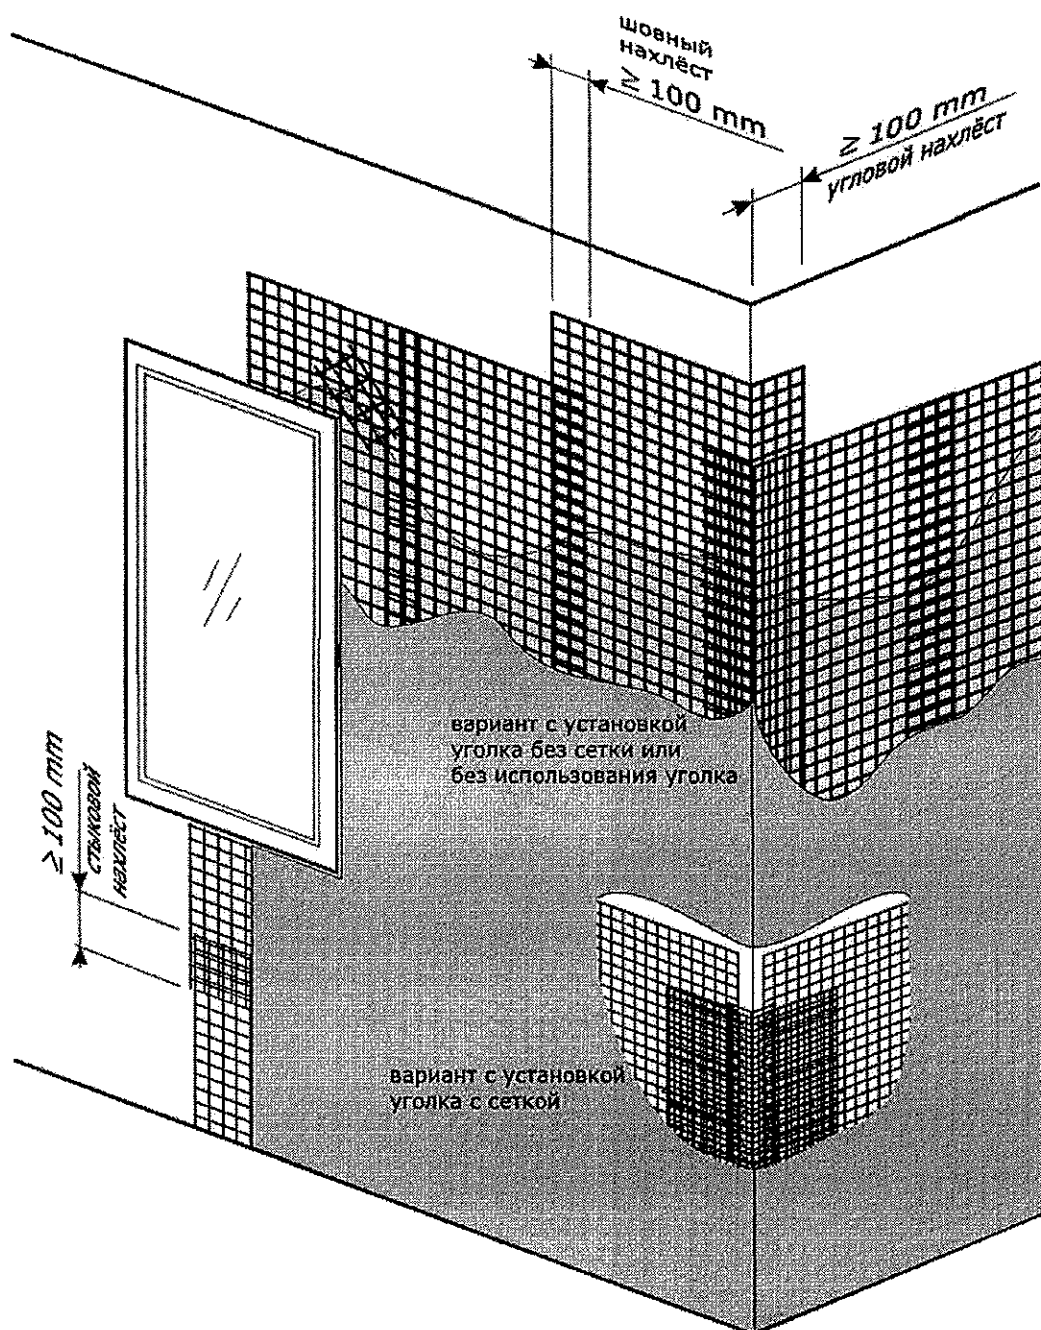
Армирование теплоизоляционных плит стеклосеткой
